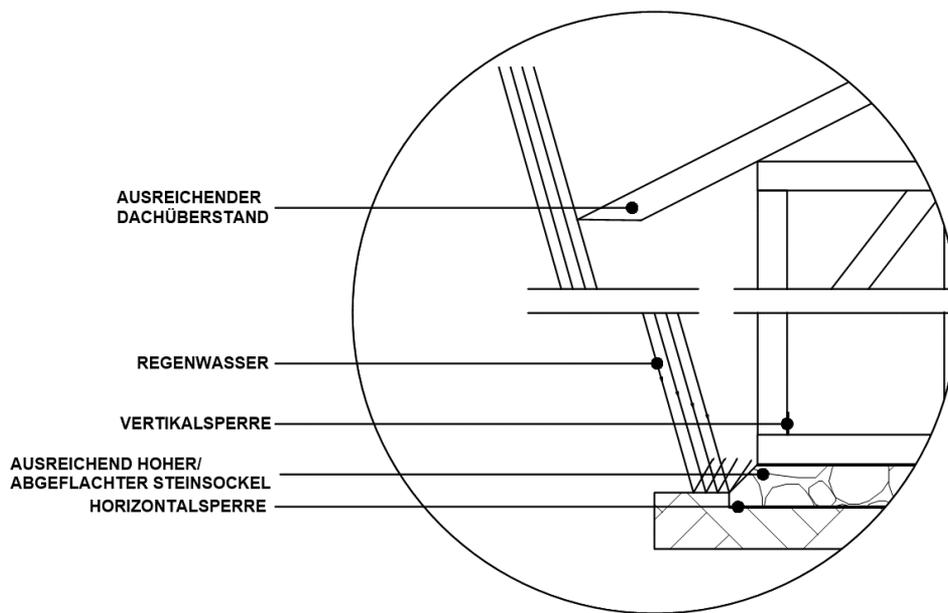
Regeneinfall bei konstruktivem Holzschutz durch ausreichendem Dachüberstand (Quelle: Bild © Sarah Belke)
